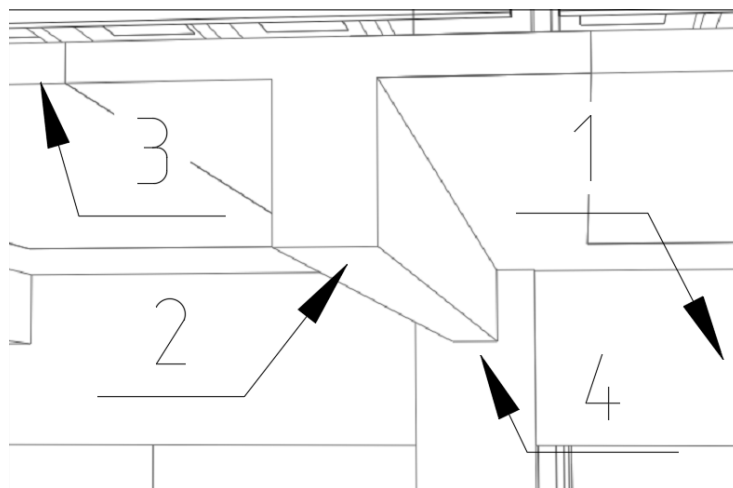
Фрагмент конструктивной модели третьего варианта (1 - главная балка, 2 - второстепенная балка, 3 – плита перекрытия, 4 - колонна)
